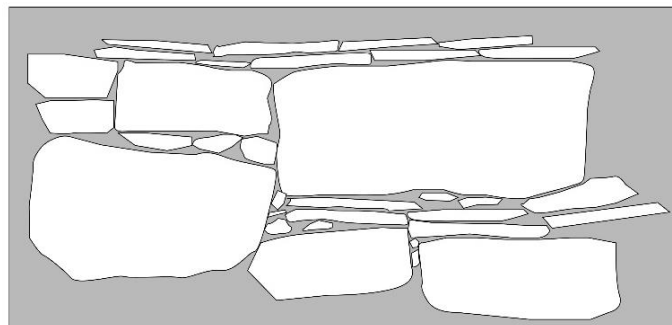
Vista de las dimensiones del recinto. Dibujo a detalle de la mampostería del paramento externo.
